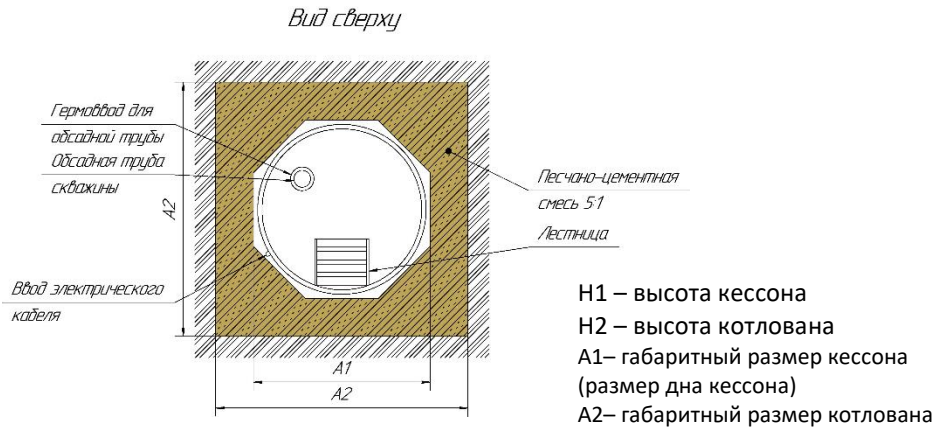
Обозначение габаритных размеров кессона КЛЕВЕР в разрезе (вид сверху)
